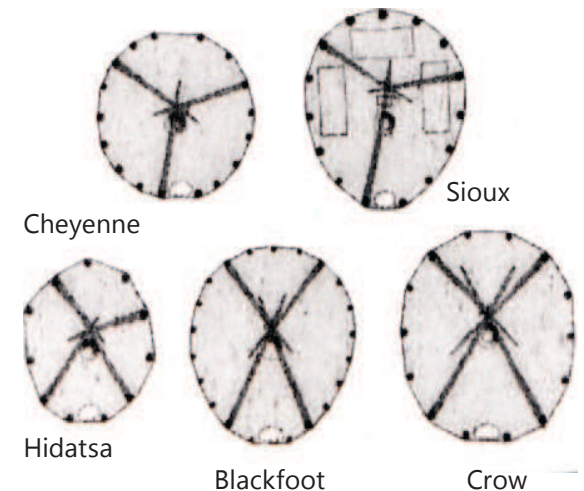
Unterschiedliche Grundrisstypen von Tipis (je nach Indianerstamm)
